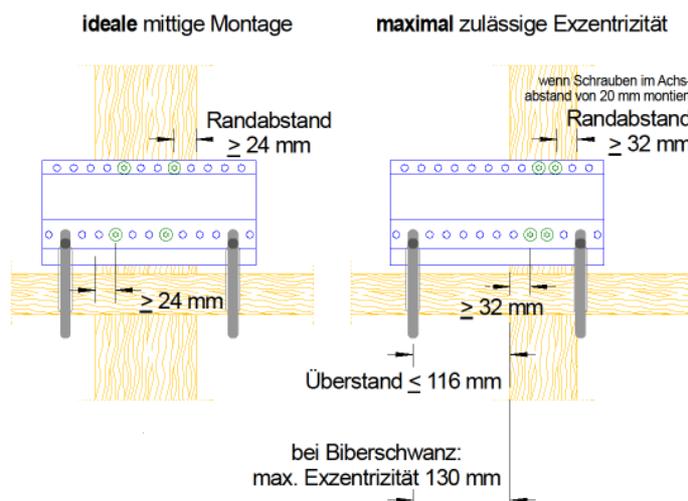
Grundprofilmontage – Doppel-Dachhaken
